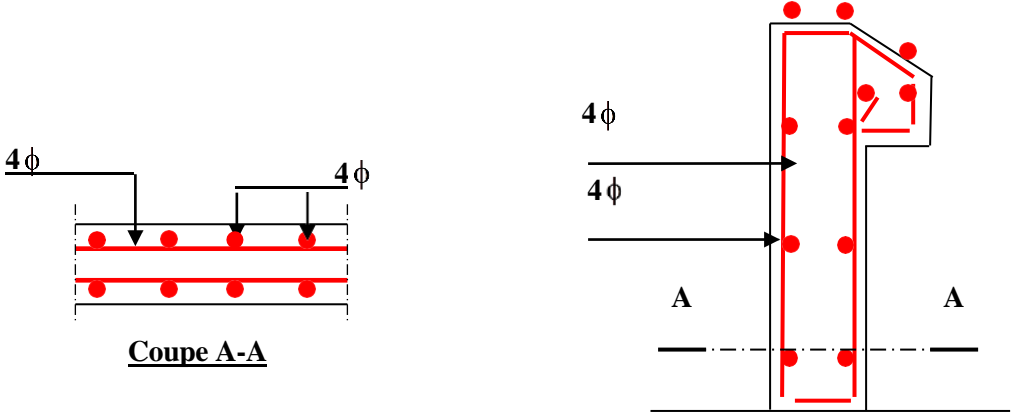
Schéma de ferrailage de l'acrotère (Terrasse inaccessible).
